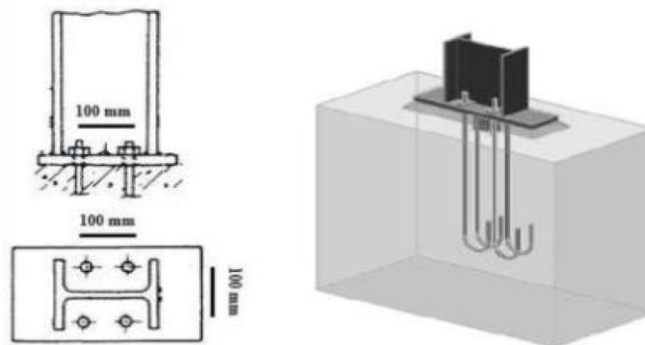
Pied de poteau articulé avec 04 boulons d'ancrage.
